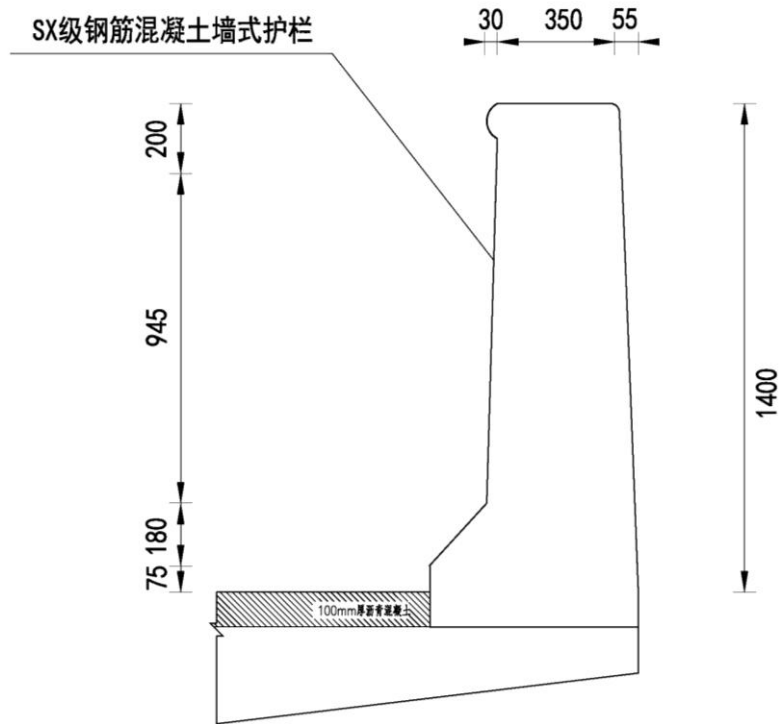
SX 级钢筋混凝土墙式护栏
